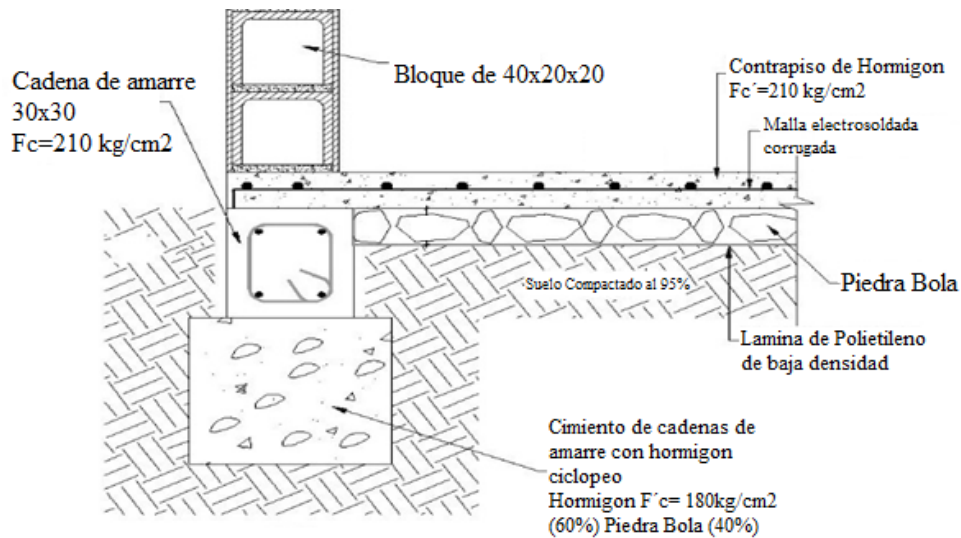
Detalle constructivo de la cadena de amarre en contrapiso.
